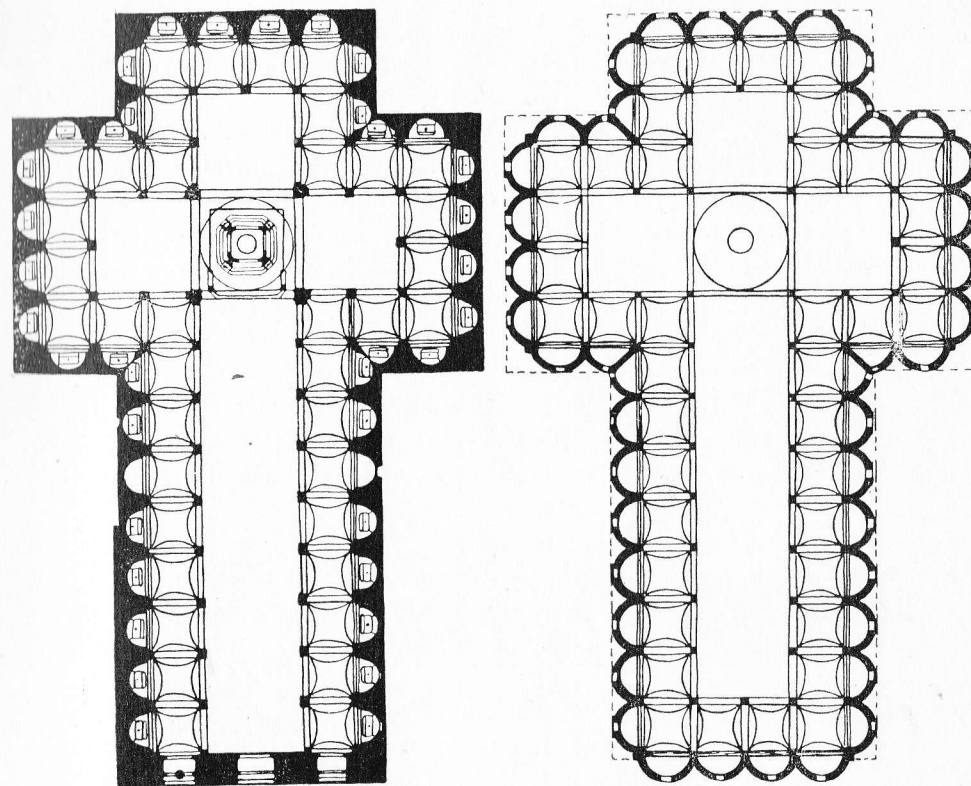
Brunelleschi; Santo Spirito, Florența (început în 1436) Plan actual și plan original.
